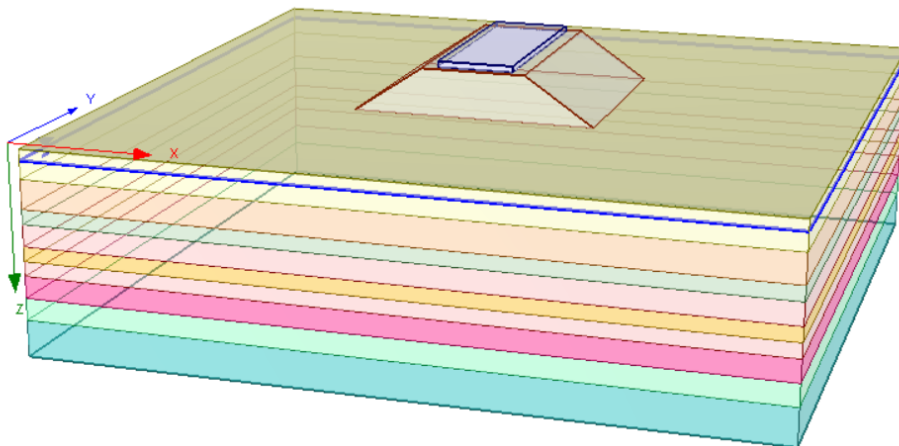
Rilevato sezione n. 26 RI39 alla pk 24+874 - Analisi SLE – Modello di calcolo – Posa Ballast
